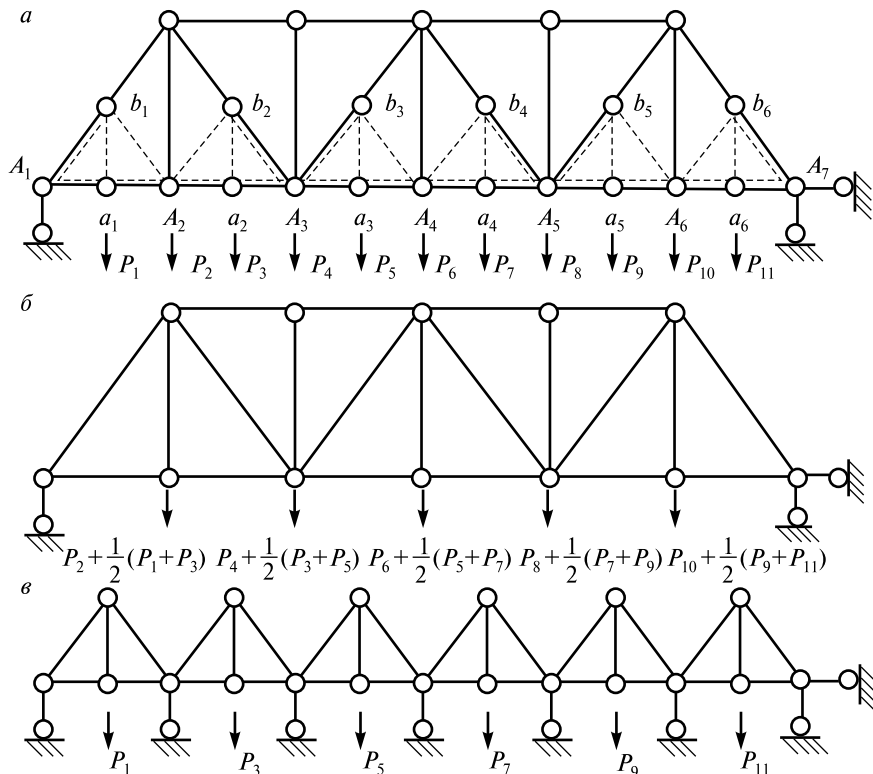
Шпренгельная ферма (а); основные узлы фермы (б); дополнительные элементы (в)
